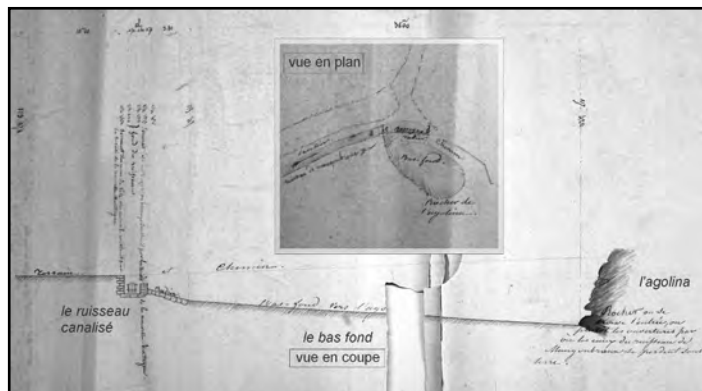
Plan Hanquet (1843), coupe et plan de l'agolina de Mangombroux
